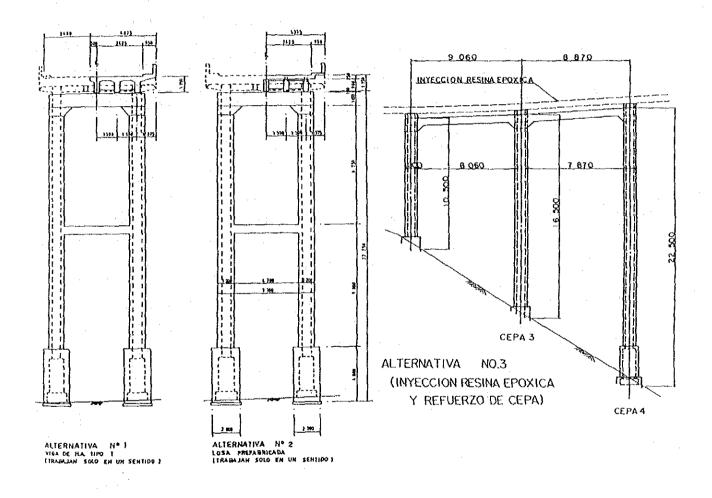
REPARACIONES DEL PUENTE AMOLANAS
